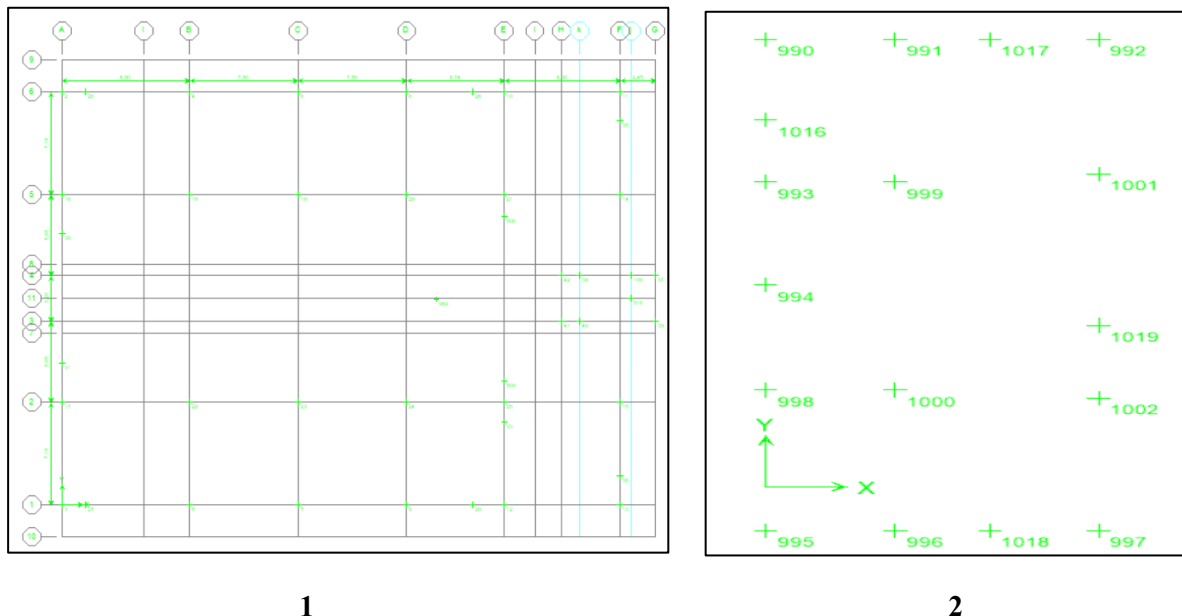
Disposition des semelles filantes sous poteaux du bloc de (1- prière, 2-d'entée).
